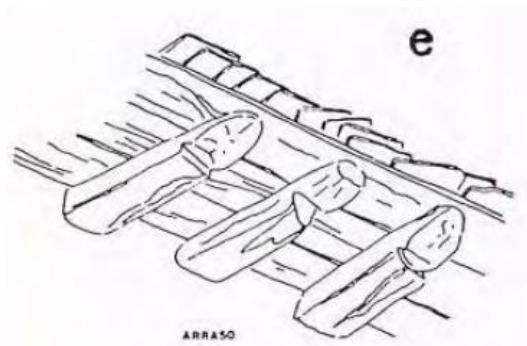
Alero con maderos de cubierta [La Casa rural en el Pirineo aragonés]
